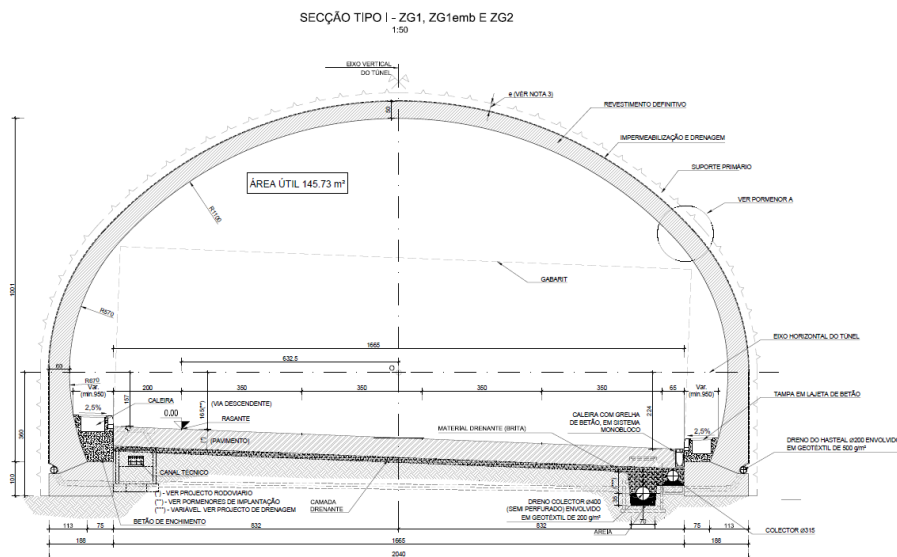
Secção Tipo I para Zonamento ZG1 e ZG2. (adaptado MDJ – TAS, 2015)
